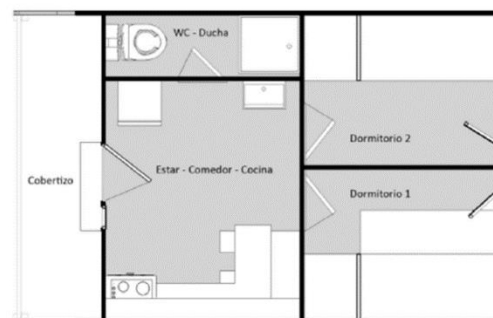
Planta con tabiques y baño. Fuente: Garay, R et all. (2014).
